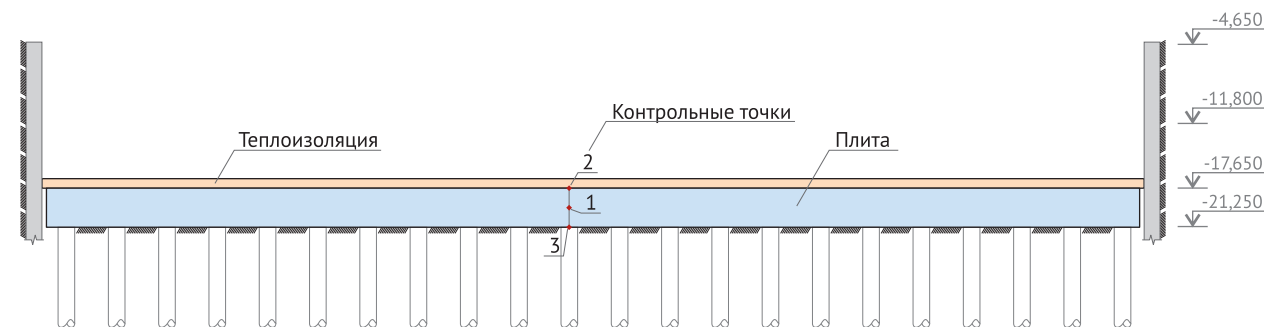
Расчётная схема фундаментной плиты: 1, 2, 3 – контрольные точки
